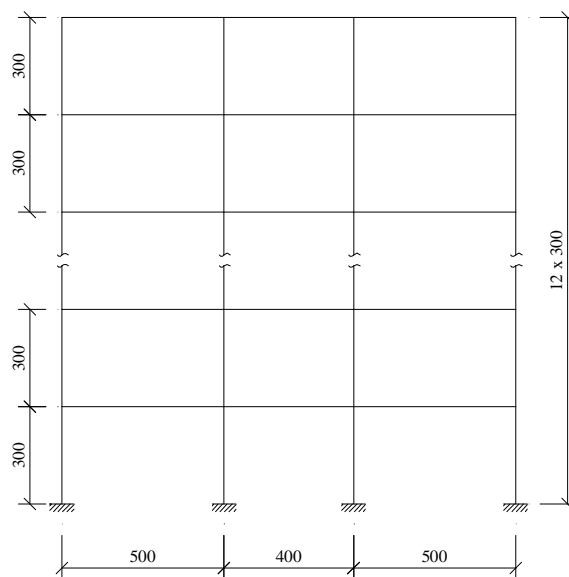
Pórtico composto de doze pavimentos e quatro pilares
